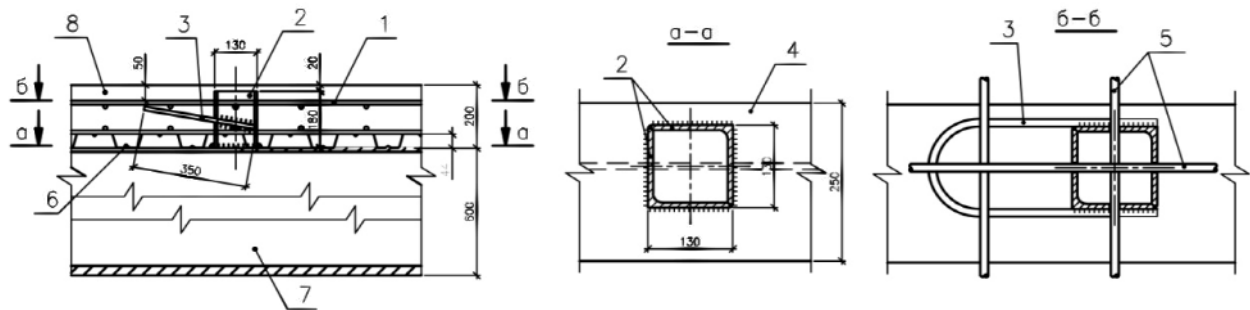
Конструкция дискретно-континуальные связи сдвига: 1 — арматурный каркас плиты; 2 — жесткий упор из уголков; 3 — арматурный выпуск; 4 — верхний пояс балки; 5 — арматура объединения с упором; 6 — профилированный настил; 7 — главные балки; 8 — железобетонная плита проезжей части
